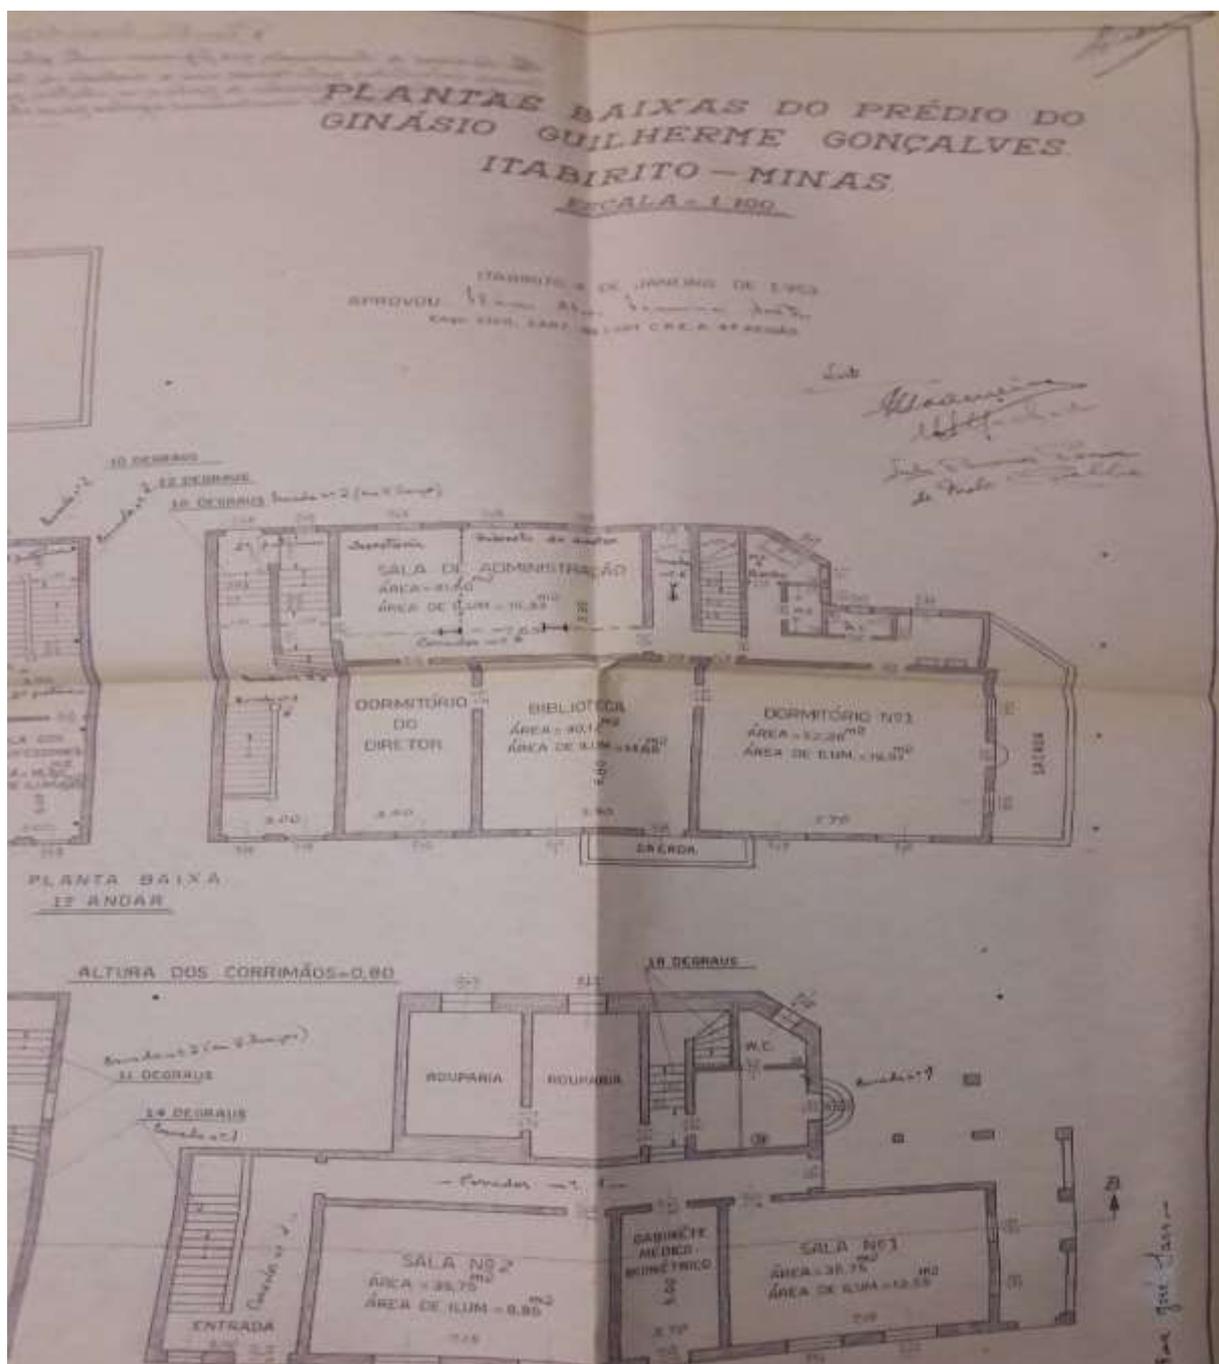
Planta baixa do primeiro pavilhão do Ginásio Guilherme Gonçalves.
